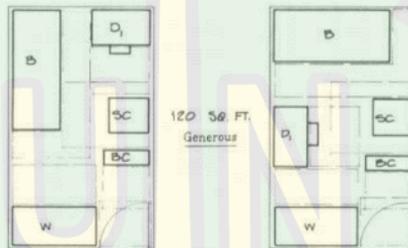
Konfigurasi Ruang Minimal *Single
